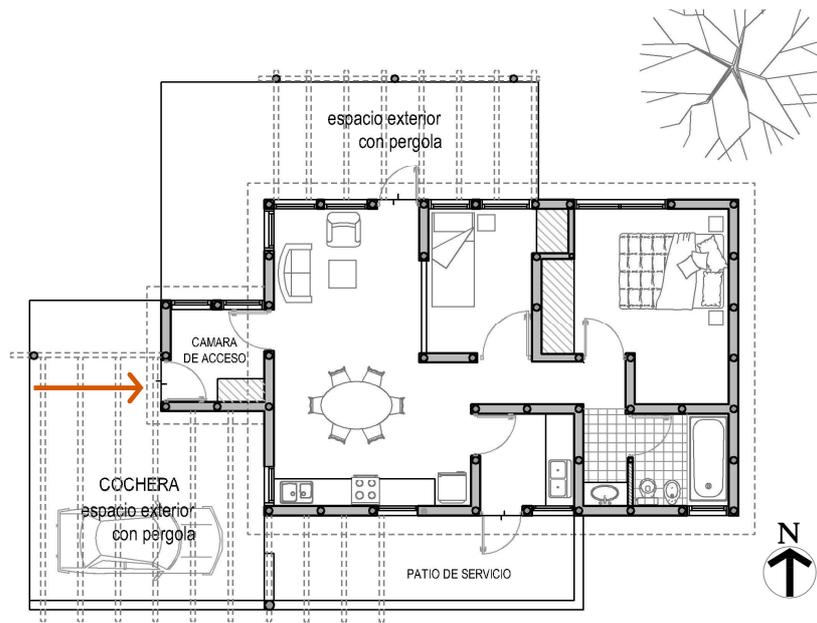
Planta de la vivienda con ingreso desde el Oeste. También se adapta al Este espejando la misma.
